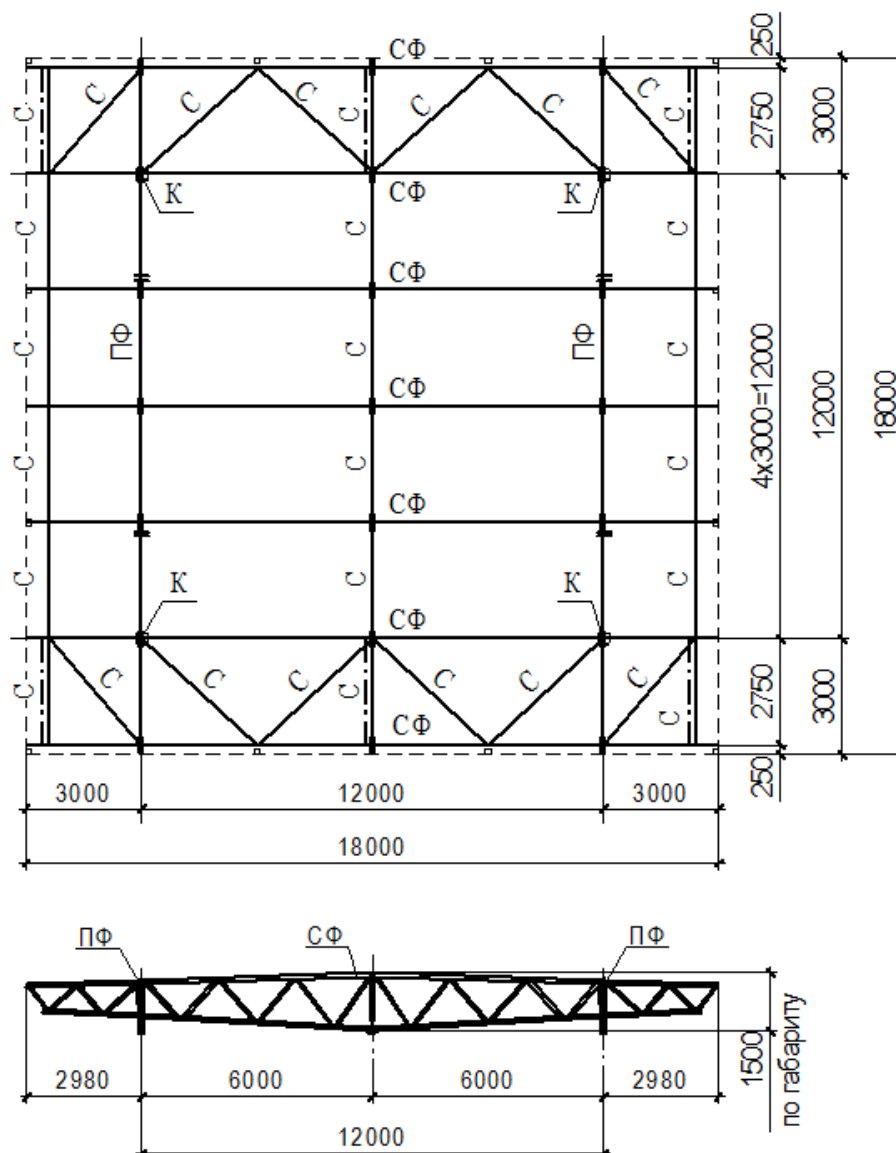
Схема покрытия по второму варианту со стропильными и подстропильными фермами
